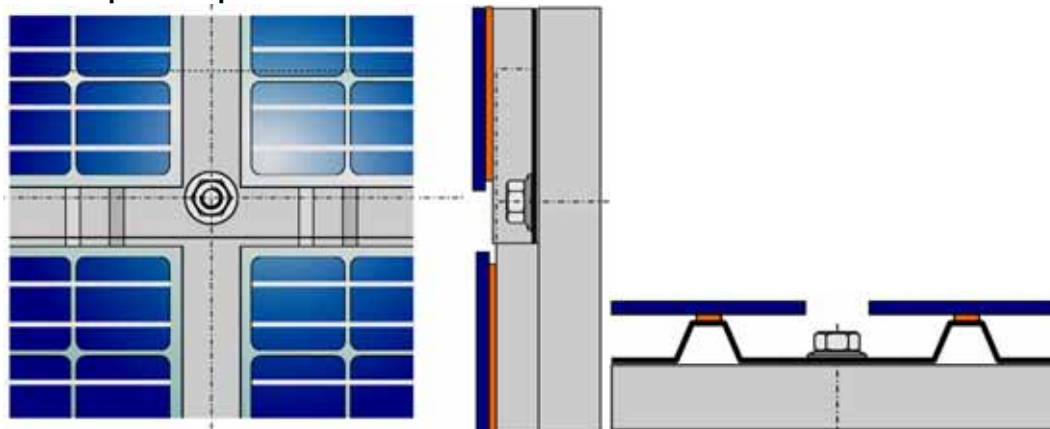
Plano superior e secções de corte transversal e longitudinal
